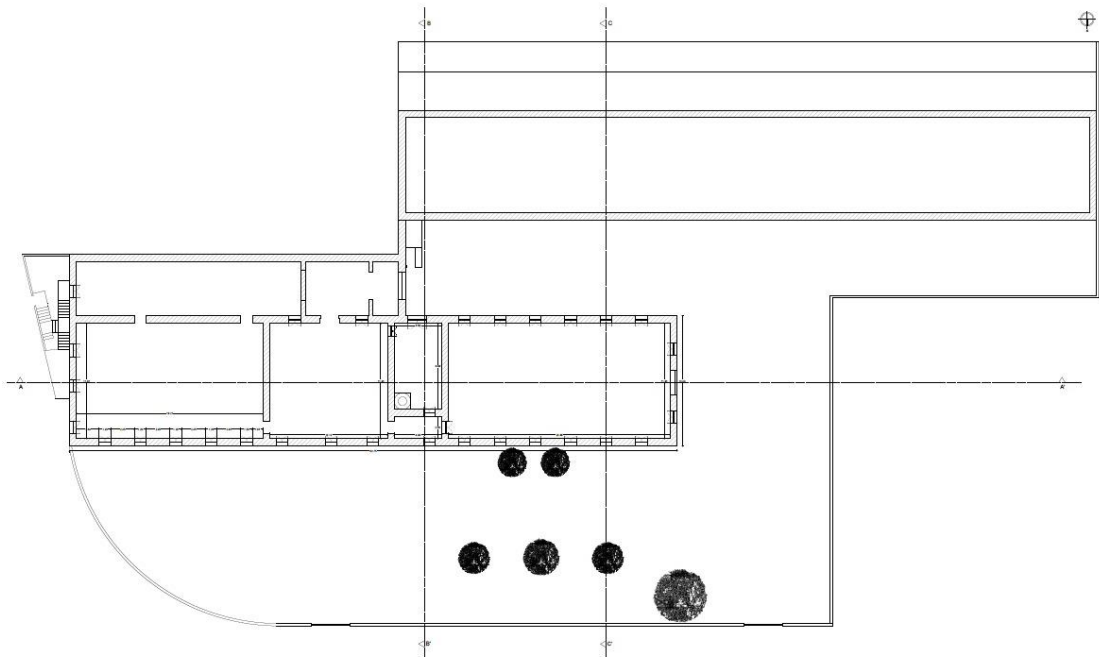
Planta de Levantamento, Antigo Lagar de Azeite
